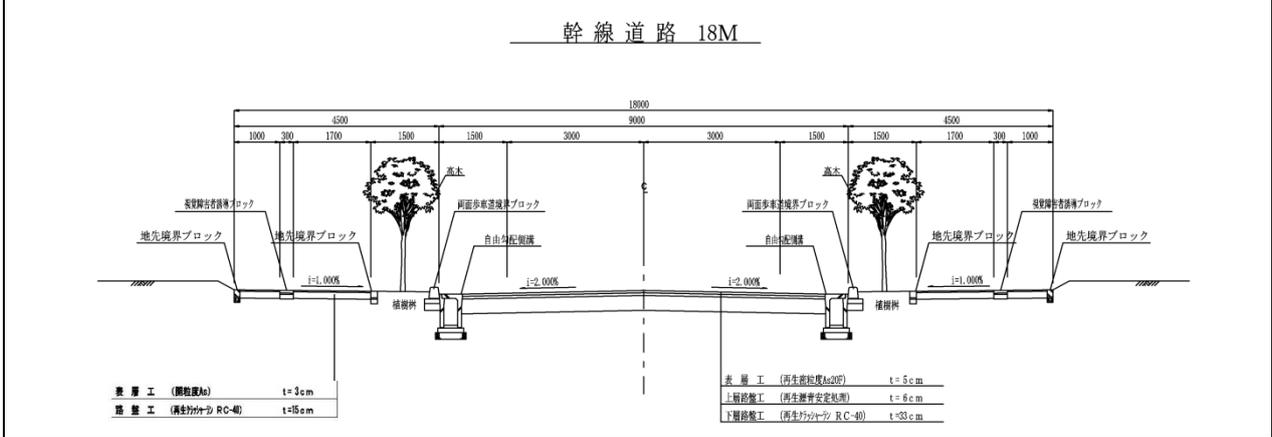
(1) 道路断面図(幹線道路:18m 標準断面)
